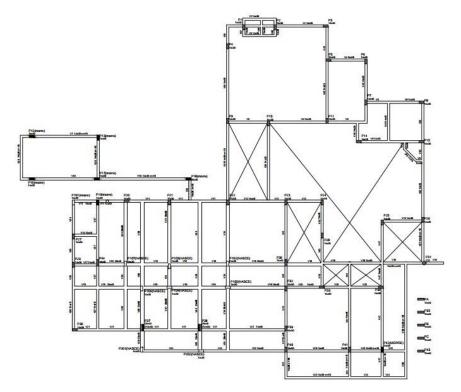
Fôrmas do Pavimento Térreo Fonte: Projeto Estrutural (2017)
